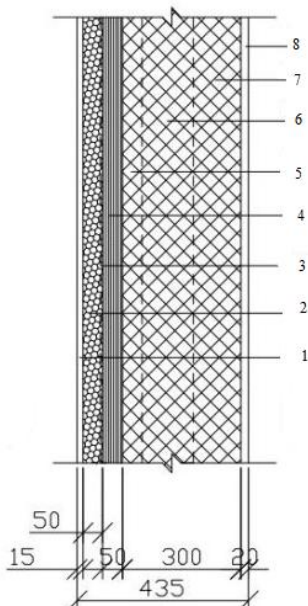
Конструкция стены дома: 1) армированная штукатурка смесями «Забудова»; 2) плита тростниковая 50 мм (горизонтальное расположение стебля); 3) пароизоляционная пленка; 4) плита тростниковая 50 мм (вертикальное расположение стебля); 5) брусок 50х50 выносной (сосна); 6) заполнение смесью глины и щепы (300 мм); 7) стойка каркаса 120х120 мм (сосна); 8) штукатурка глиняным раствором
